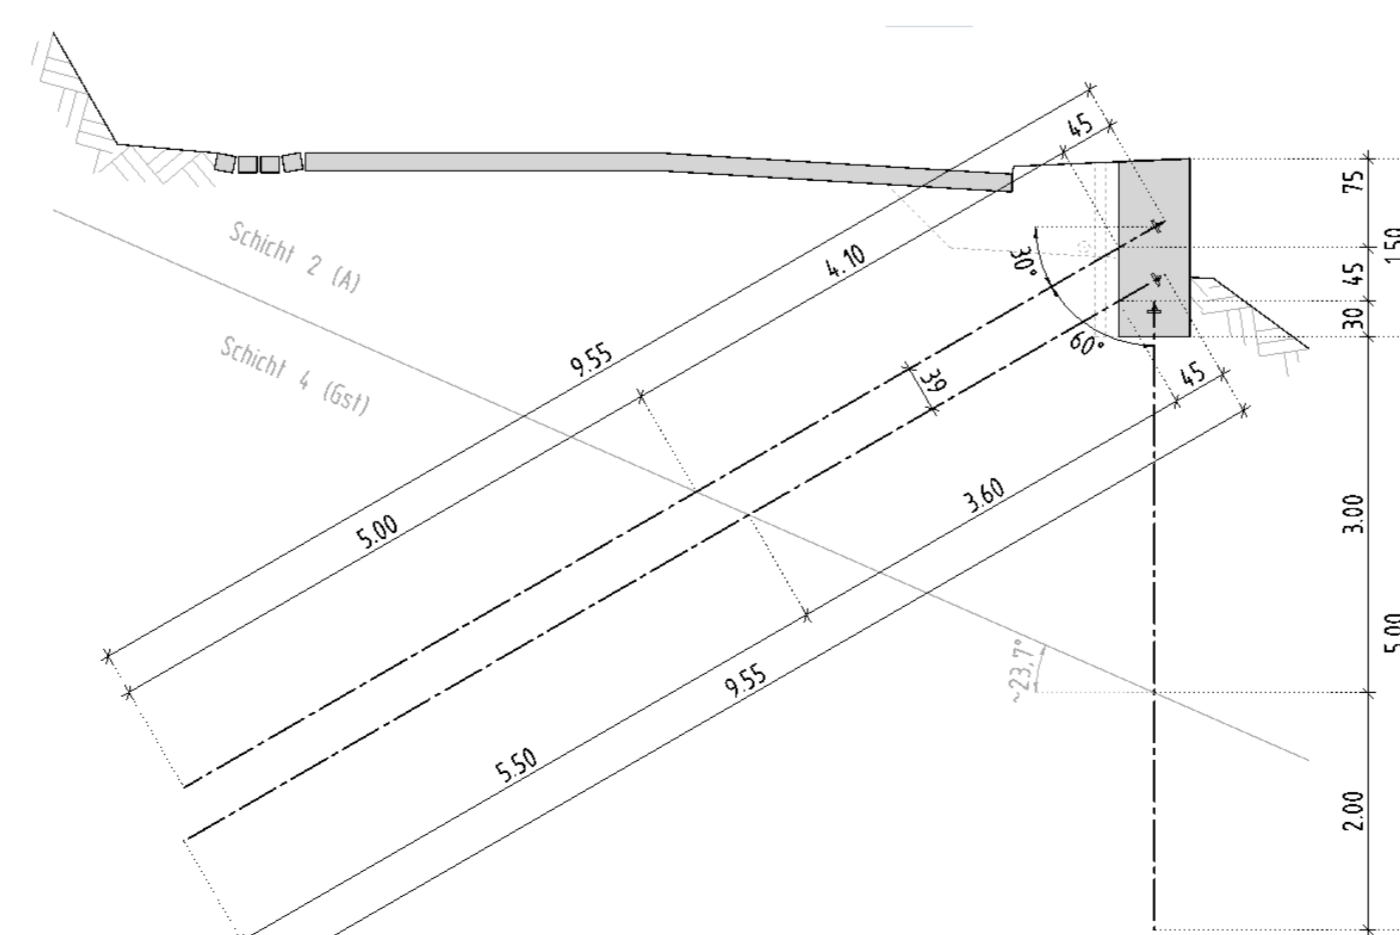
Vorzugsvariante Stahlbetonbalken mit Rückverankerung
